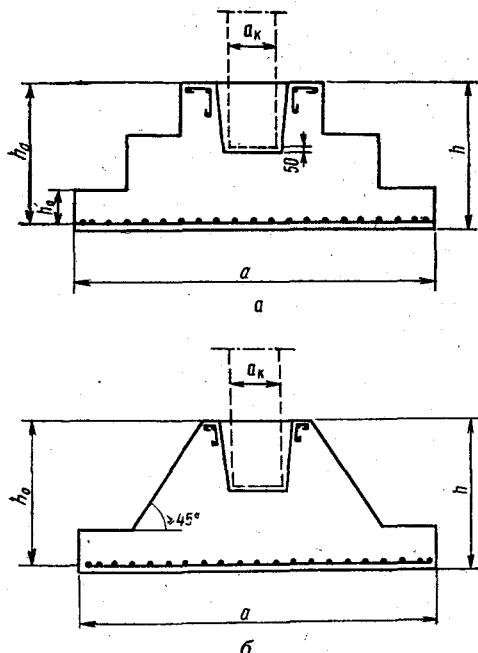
Железобетонные отдельностоящие фундаменты (башмаки) под сборные колонны: а—ступенчатый; б—пирамидальный.
